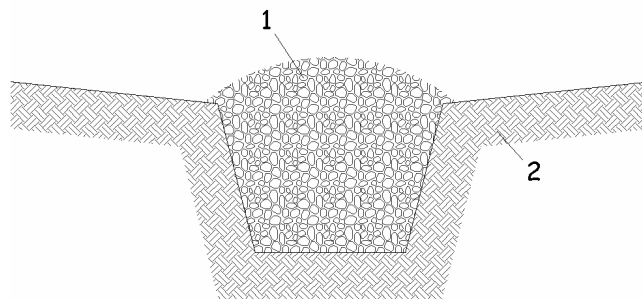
Sezione tipo canale filtrante collettore. Legenda: 1) filtro drenante; 2) sezione di scavo
